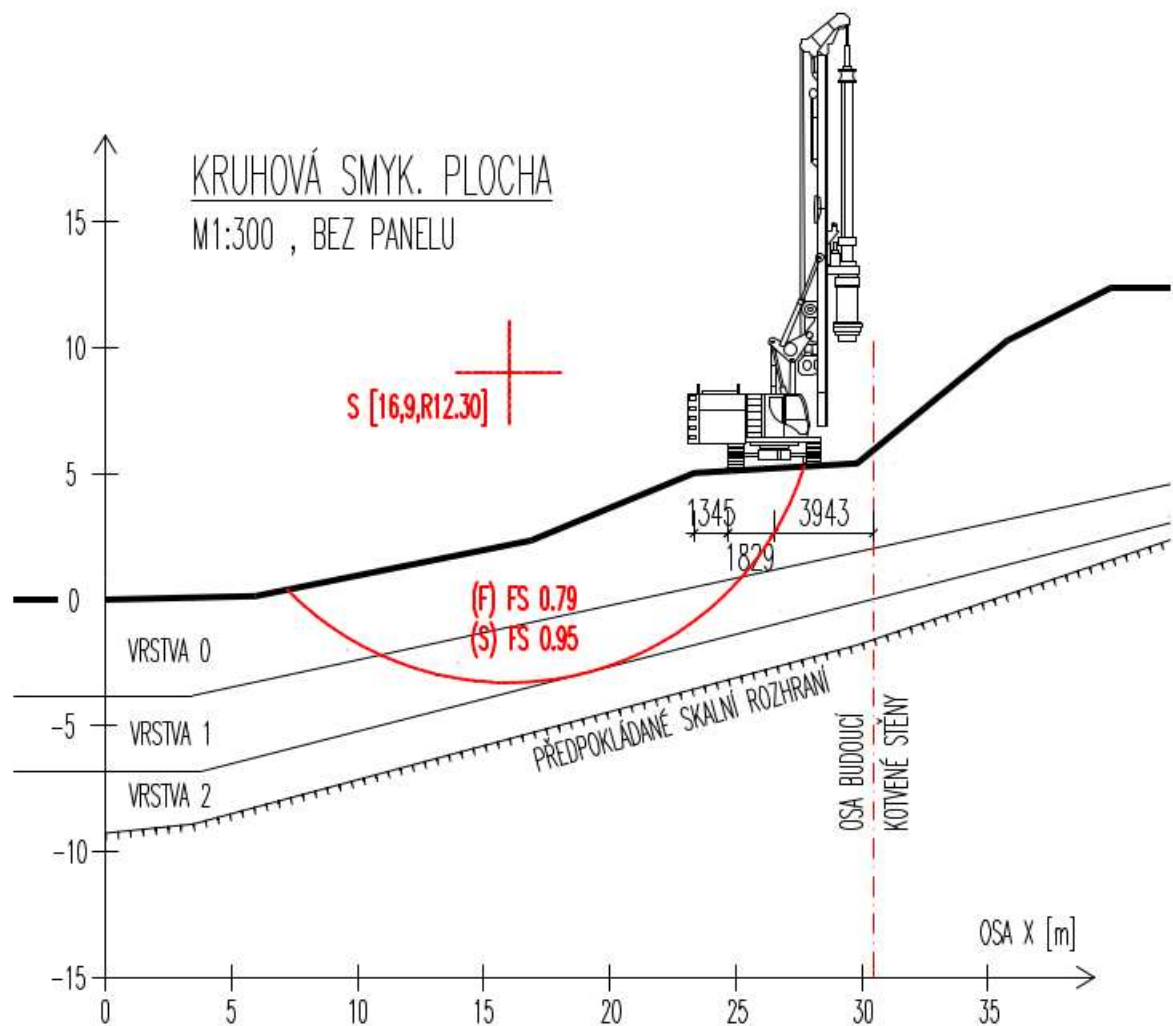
MANIPULAČNÍ PROSTOR SOUPRAVY [22]
